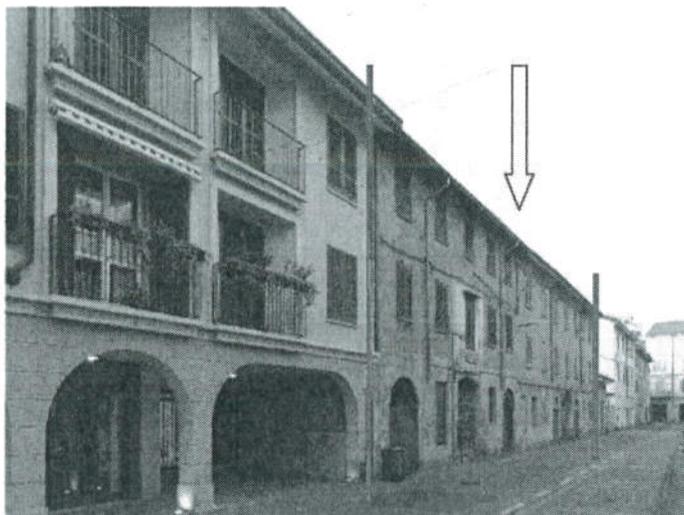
edificio di corte in linea, oggetto del PR in variante.
